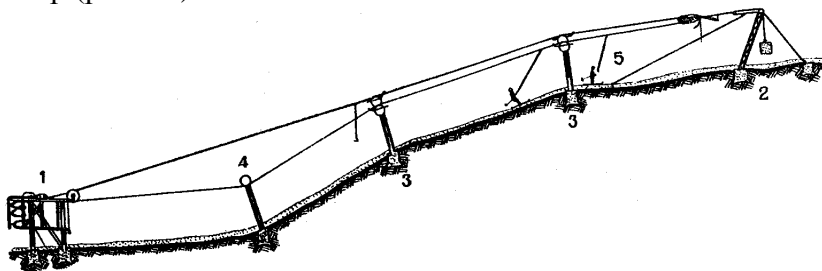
Бугельний витяг: 1 – нижня станція, 2 – верхня станція, 3 – опори, 4 – роликовий механізм, 5 – бугель
